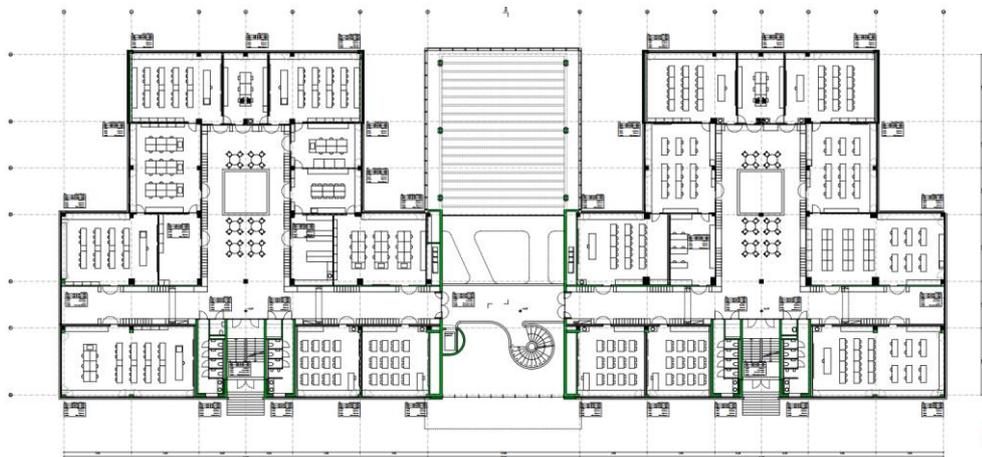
Pianta primo piano – Durisch + Nolli Architetti sagl
